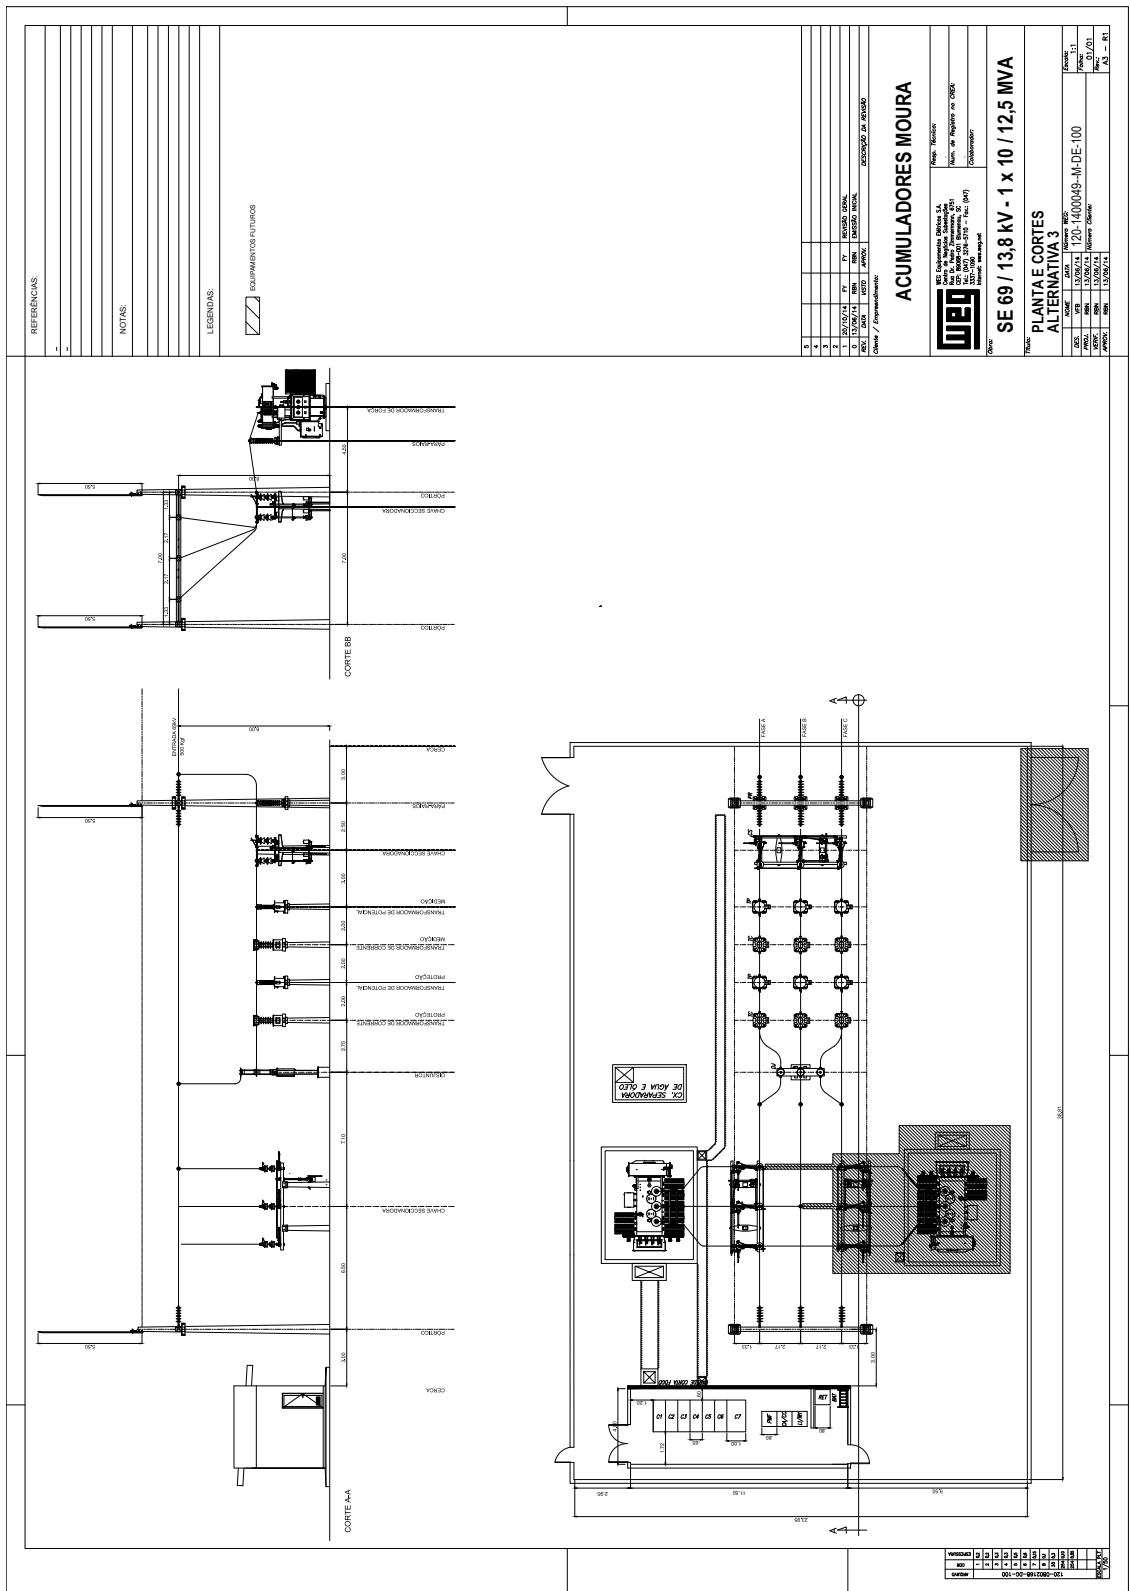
Planta baixa da SE de 69/13,8 kV.
